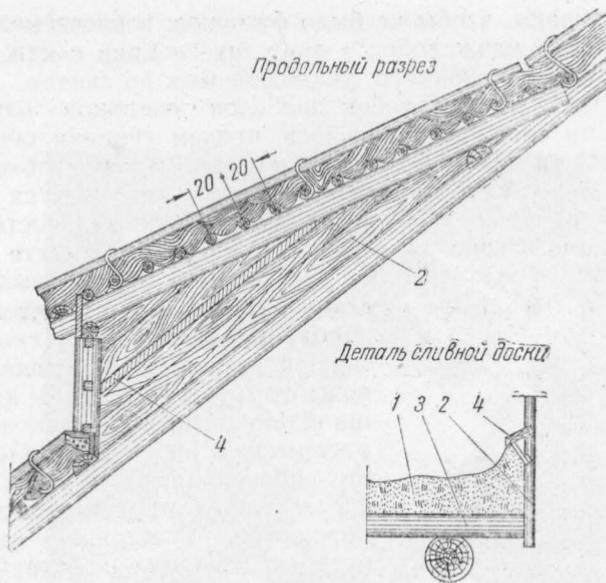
Покрытие слухового окна глино-соломенной кровлей и деталь примыкания кровли к стене:
